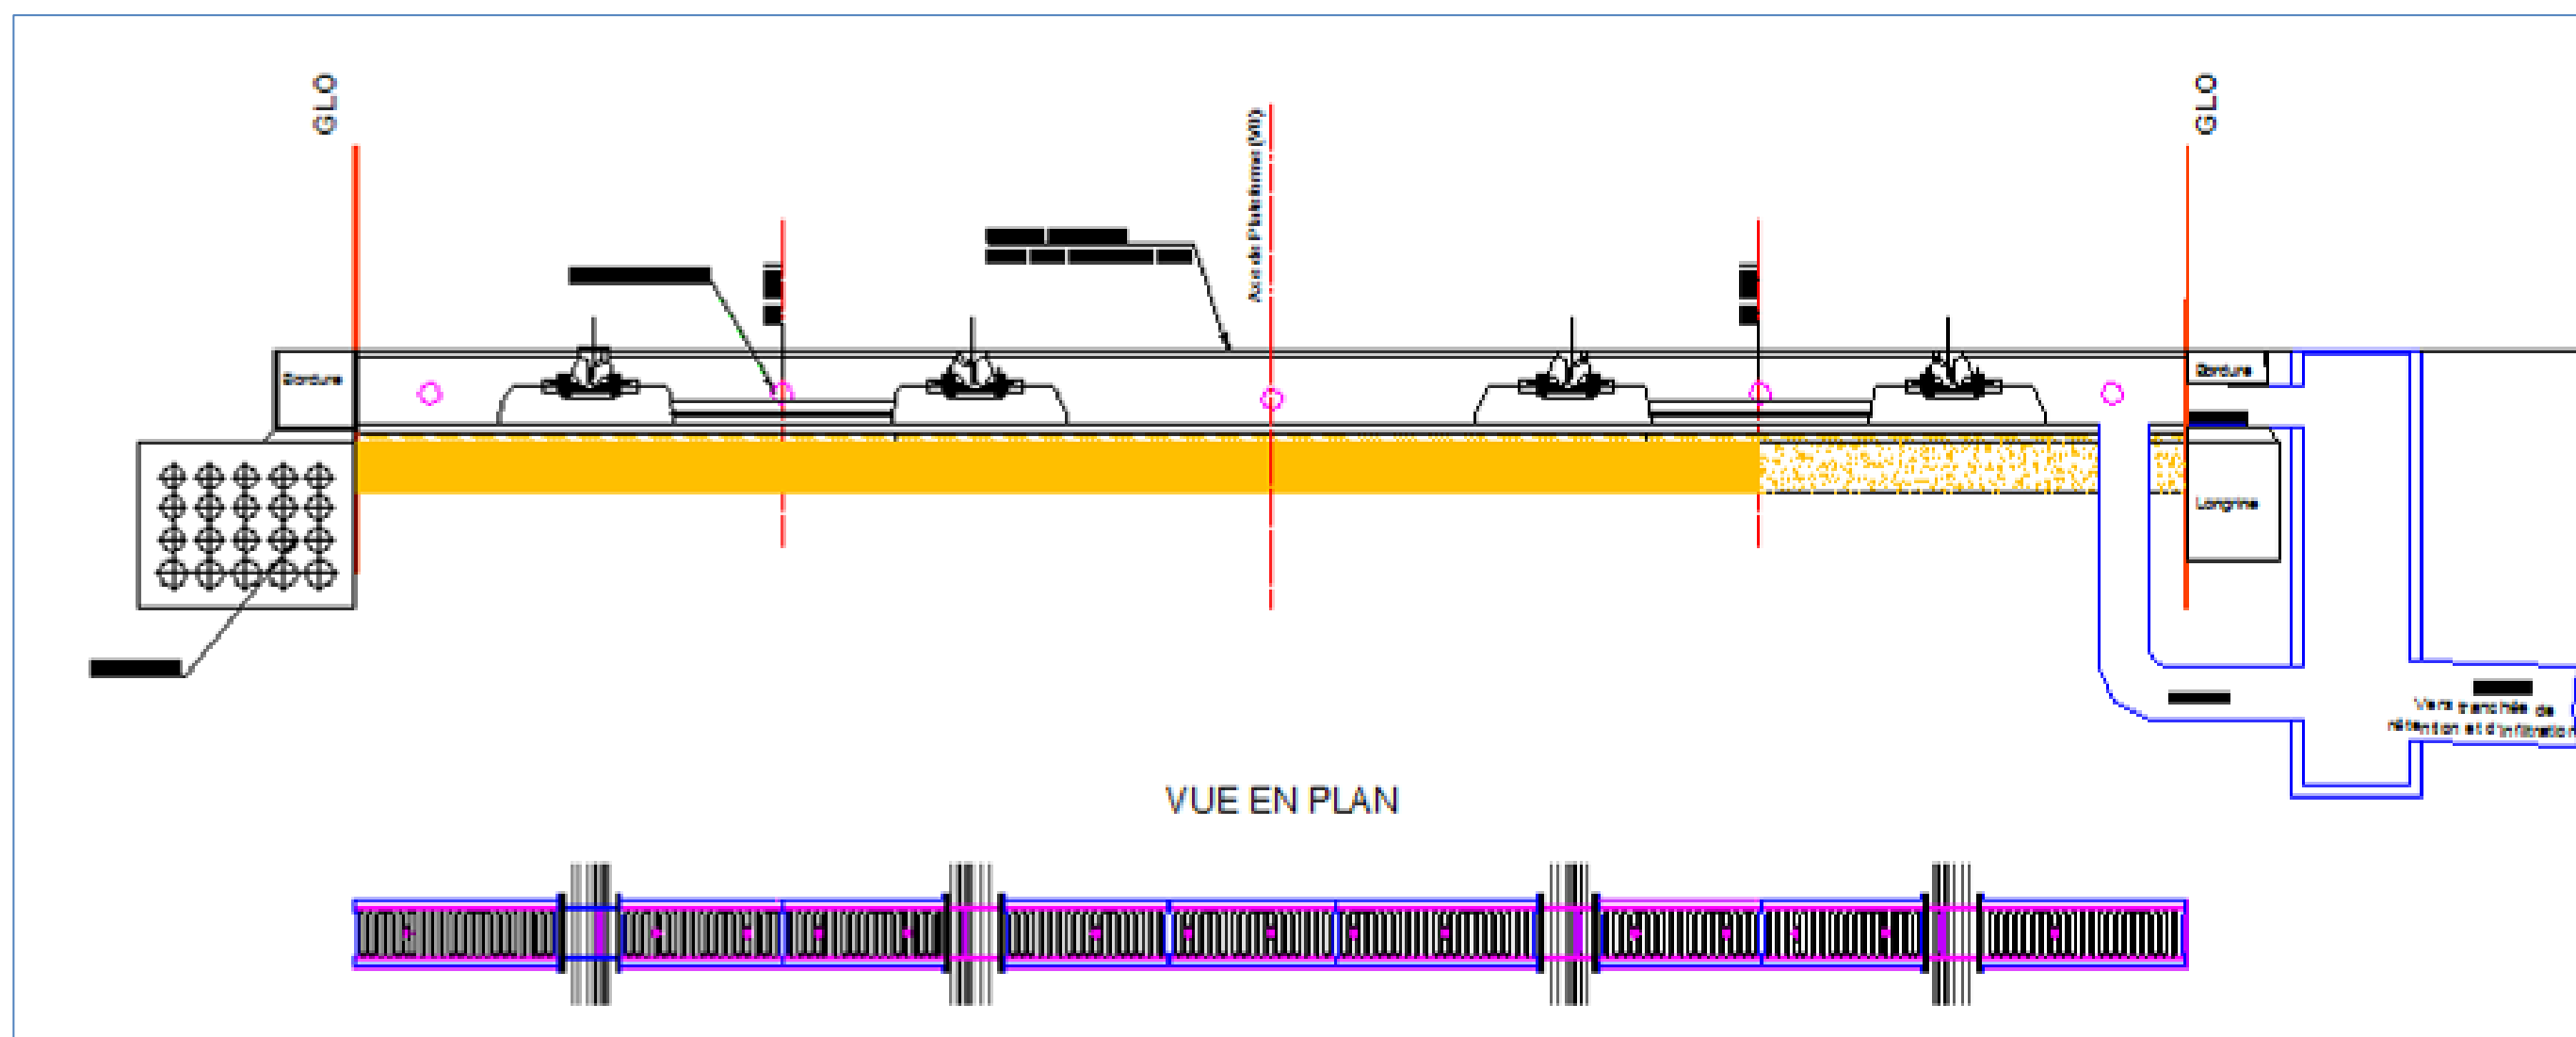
Coupe de principe des dispositifs d'assainissement au droit de la plateforme minérale
